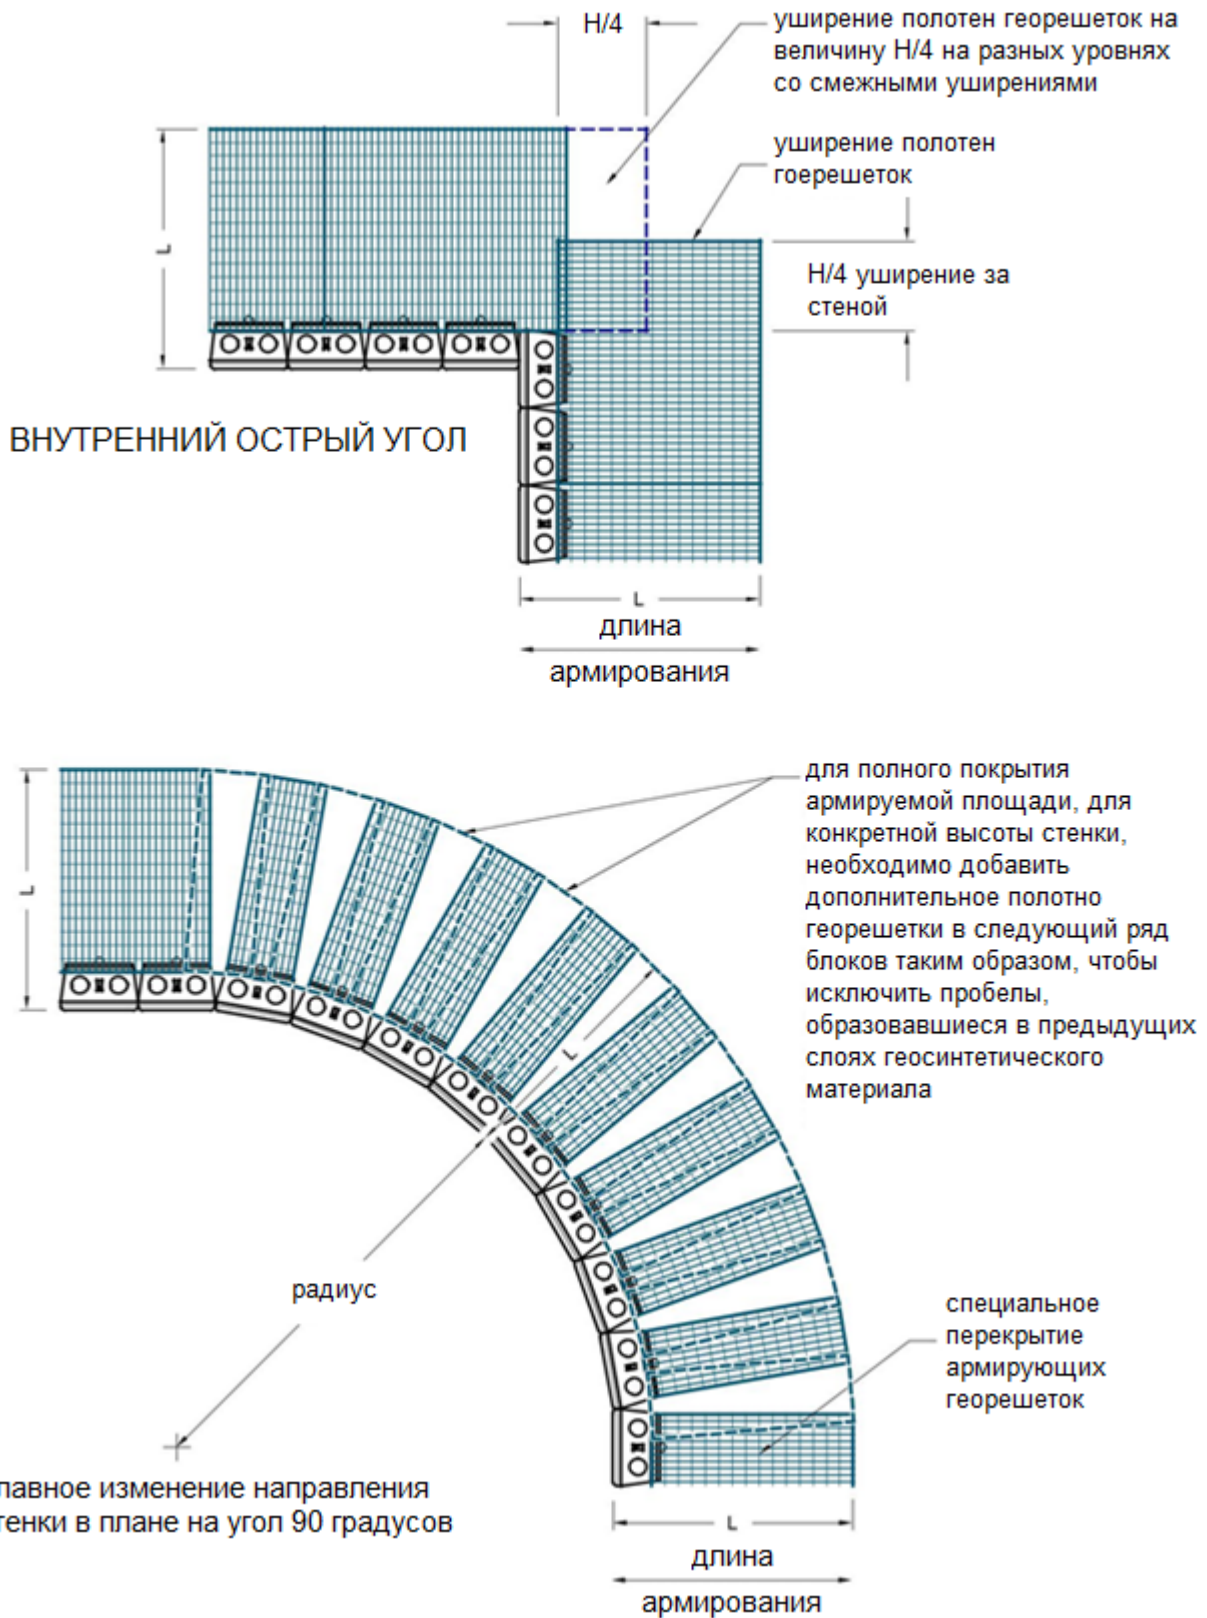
Расположение армирующих георешеток в стенках типа АГ 2 с внутренними углами поворотов в плане
